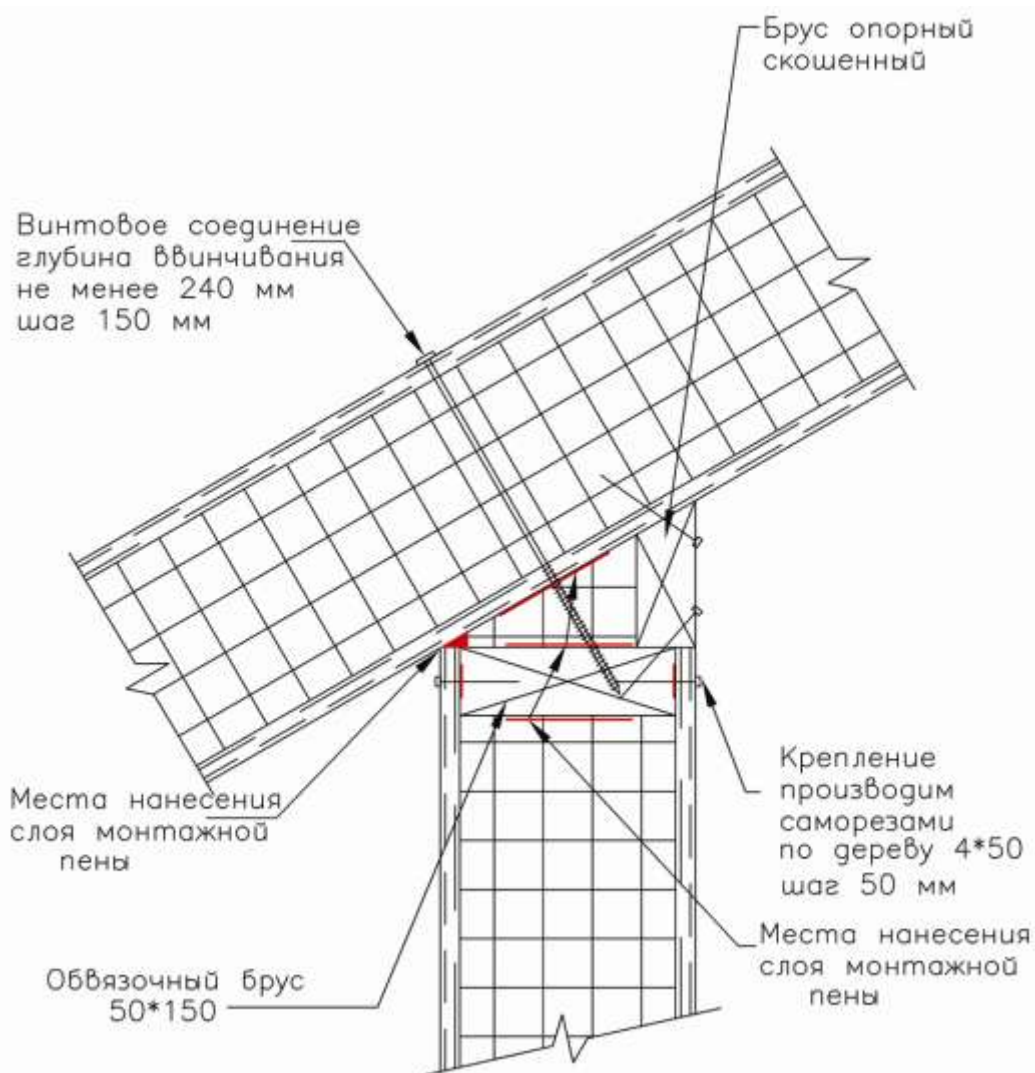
Соединение стеновой панели с кровельной. Вариант №2
